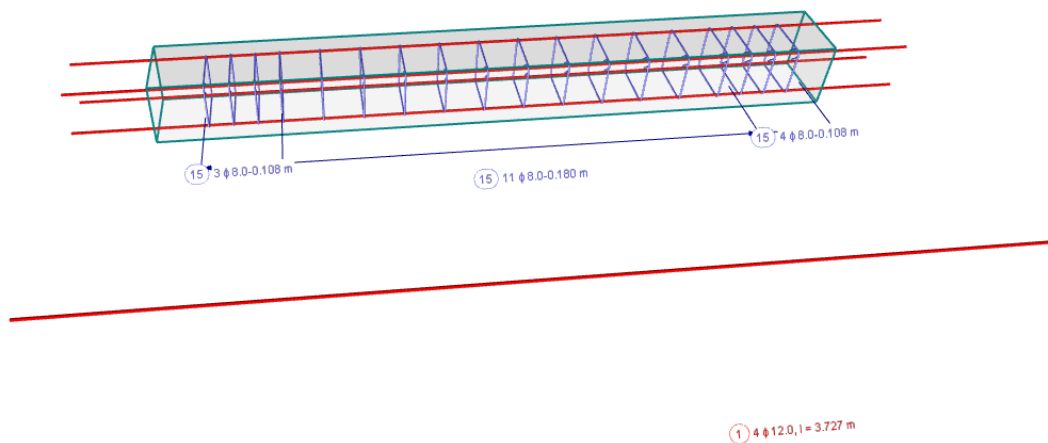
Armadura existente en las columnas de hormigón armado del sótano.
